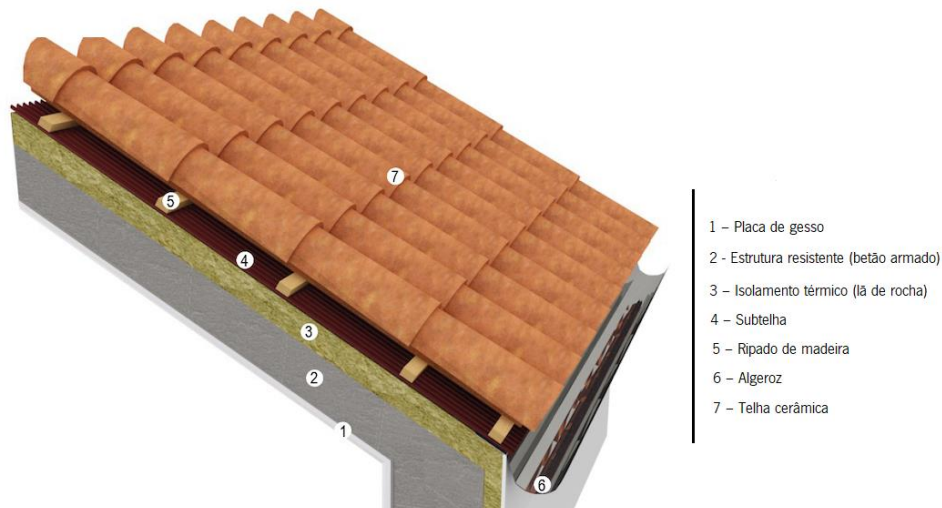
Pormenor construtivo de cobertura inclinada com subtelha (adaptado de (Portal de arquitetura e construção sustentável, 2020))
